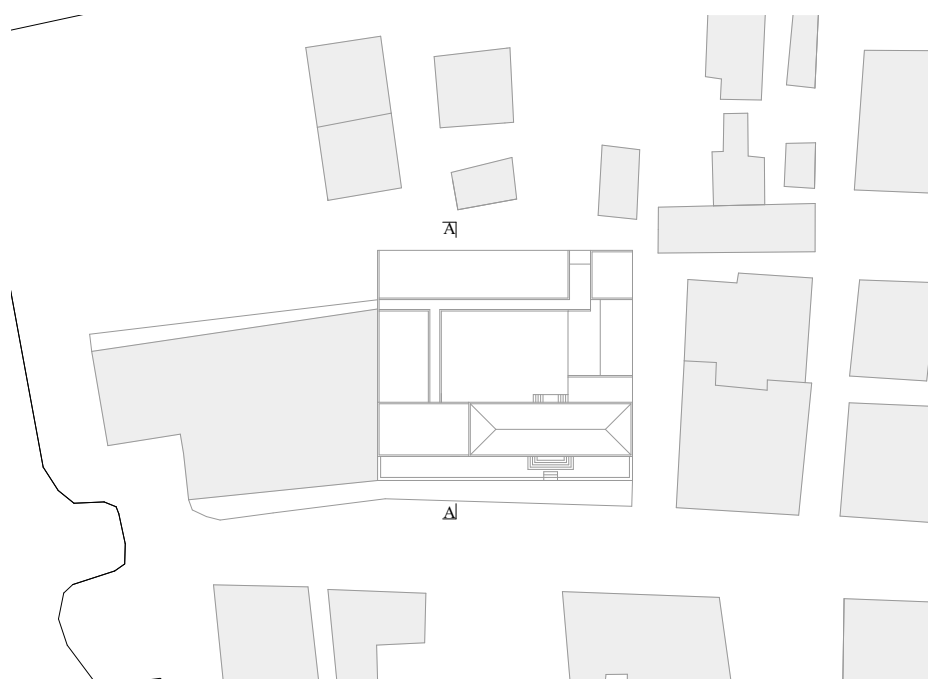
Planta de implantação do edifício da Escola de Ponta do Sol. Esc. 1/1000.
